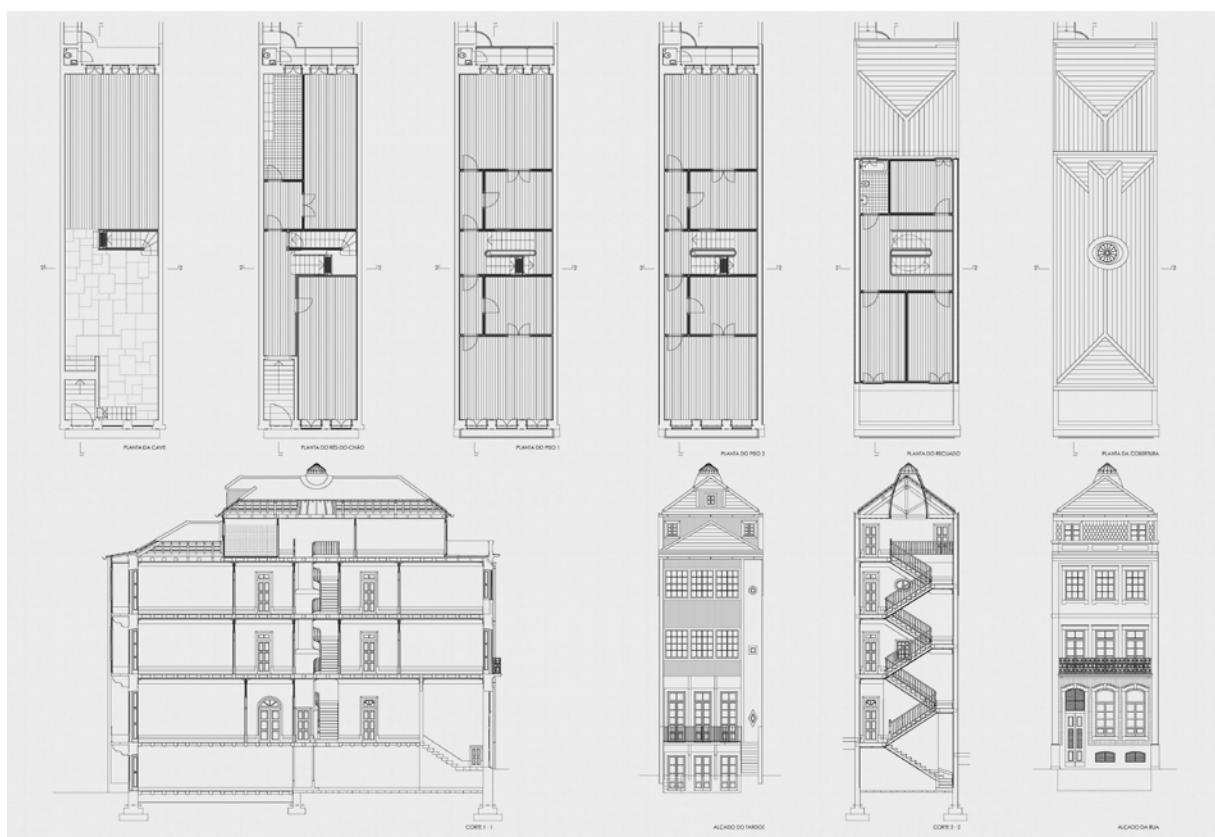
Plantas, cortes e alçados do modelo construtivo.
